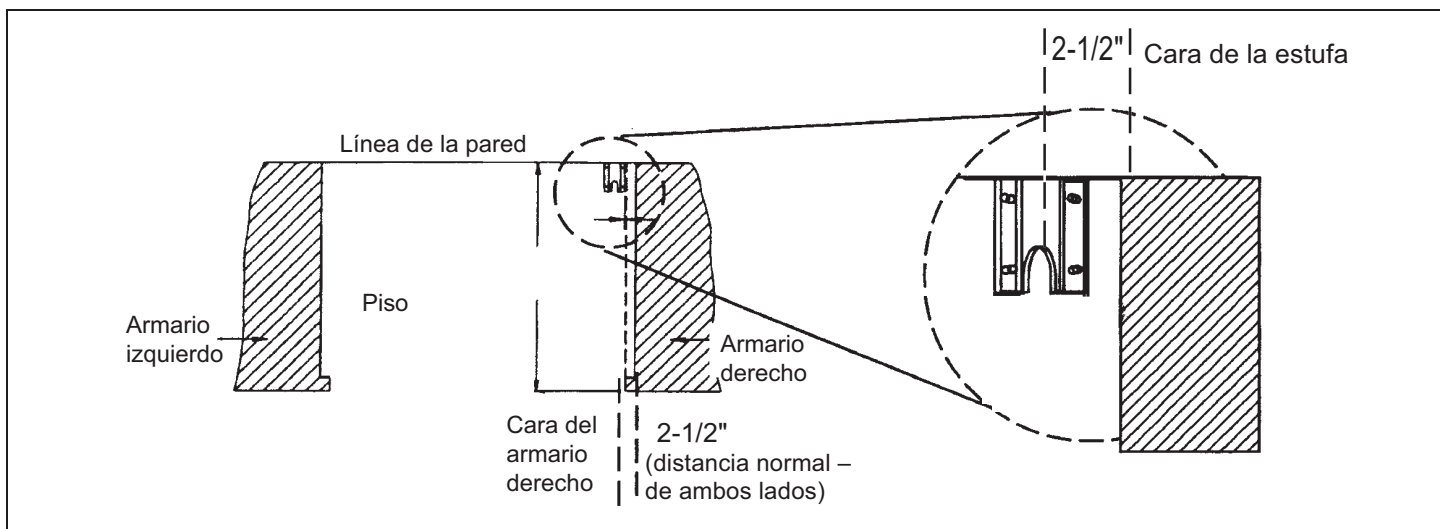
Ubicación del dispositivo antivuelco (vista en planta)
